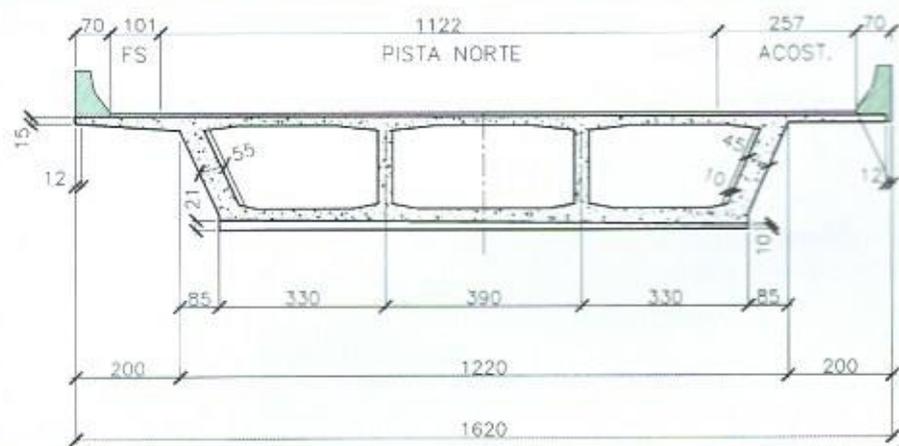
Passagem Inferior no km 39: Seção Transversal no vão de 38 m.
